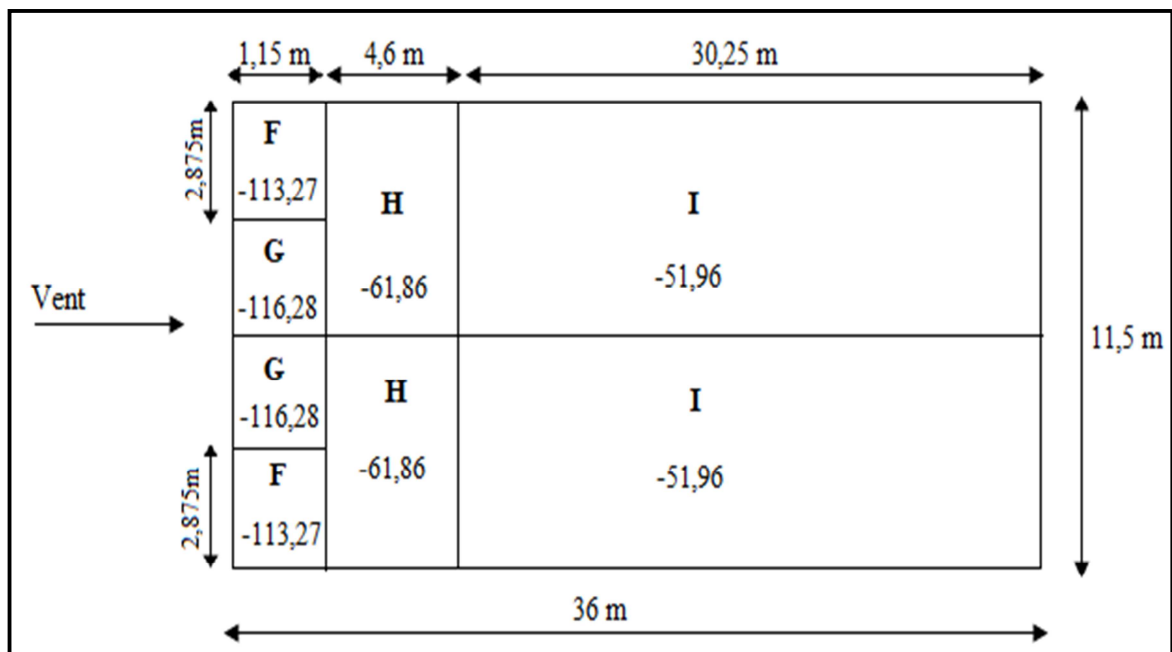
Pressions sur la toiture directions du vent (V1,V3) [daN/m²].
